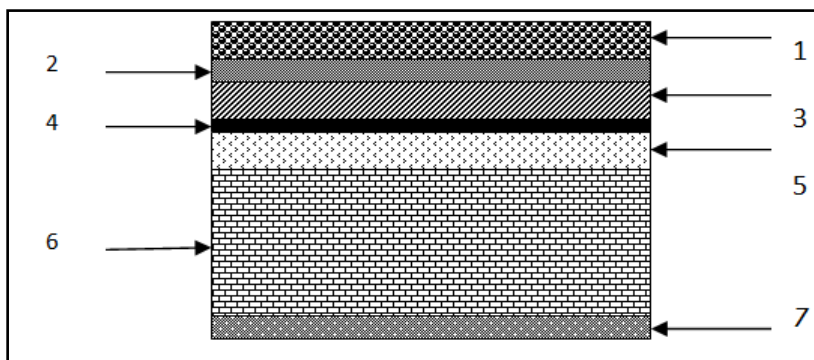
Coupe transversale au niveau de plancher étage terrasse.
